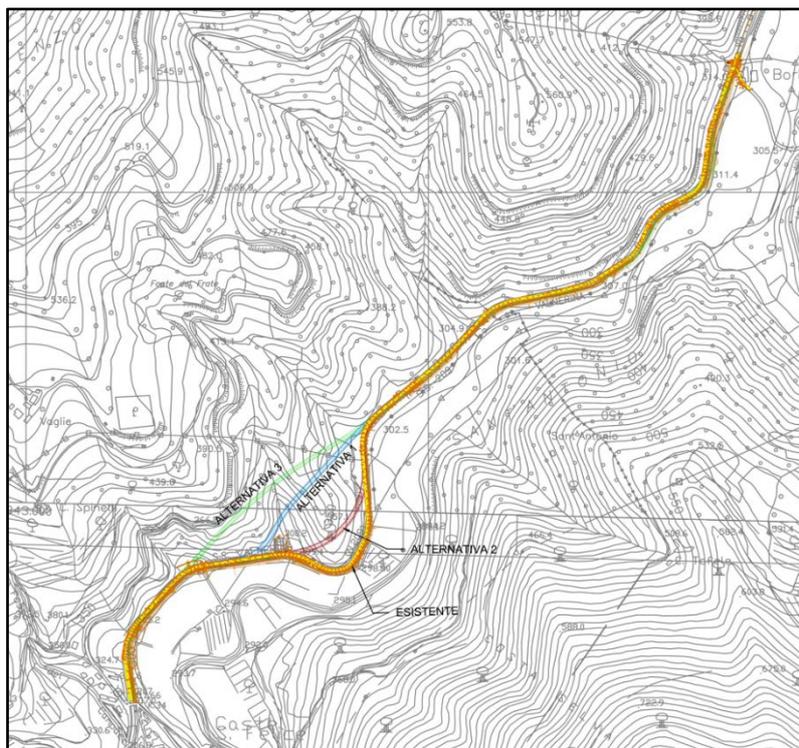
Sviluppo planimetrico dei tracciati alternativi di progetto.
